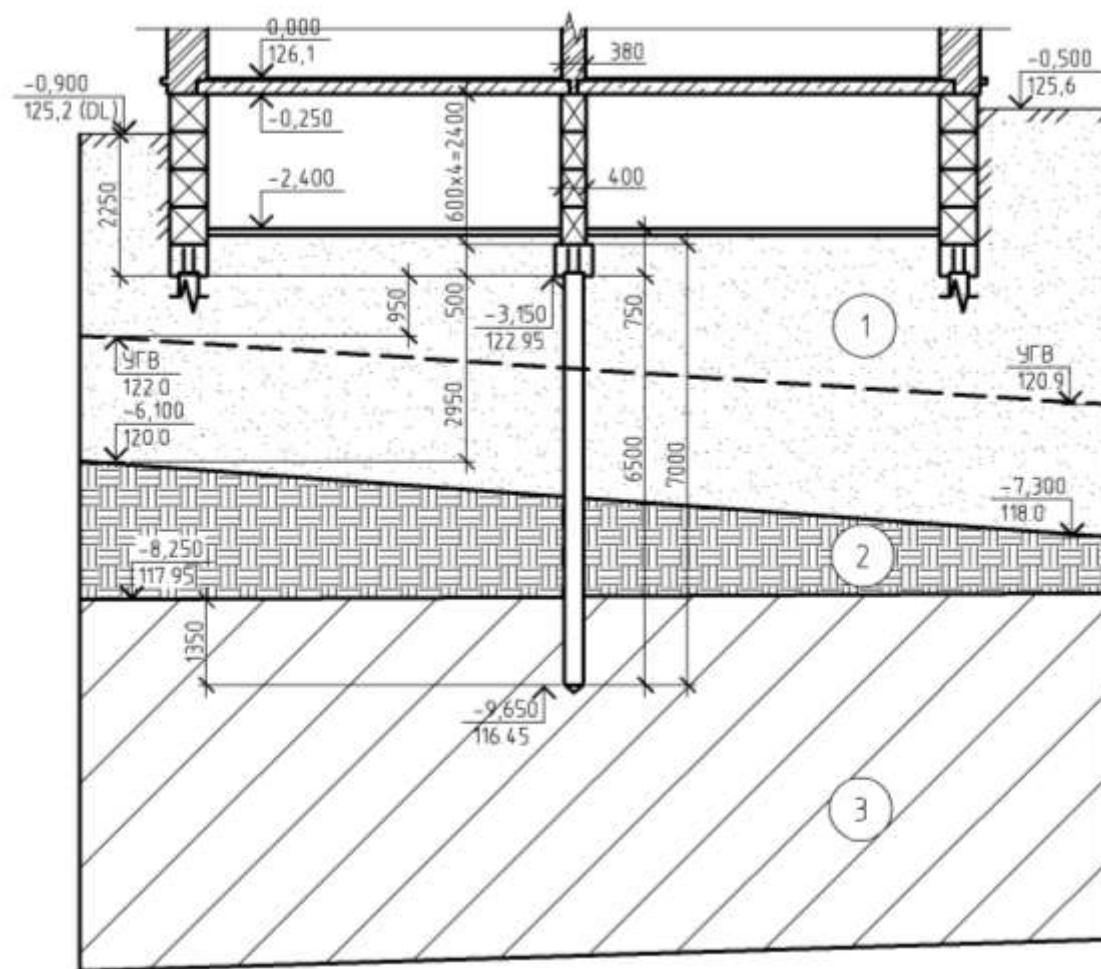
Схема к предварительному выбору свайного фундамента под несущие стены
